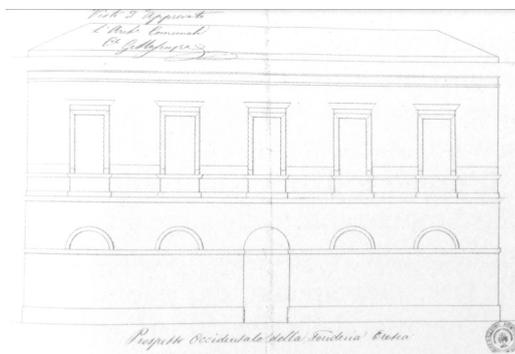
Prospetto Fonderia Oretea, 1862. Fonte Di Benedetto (2011)
